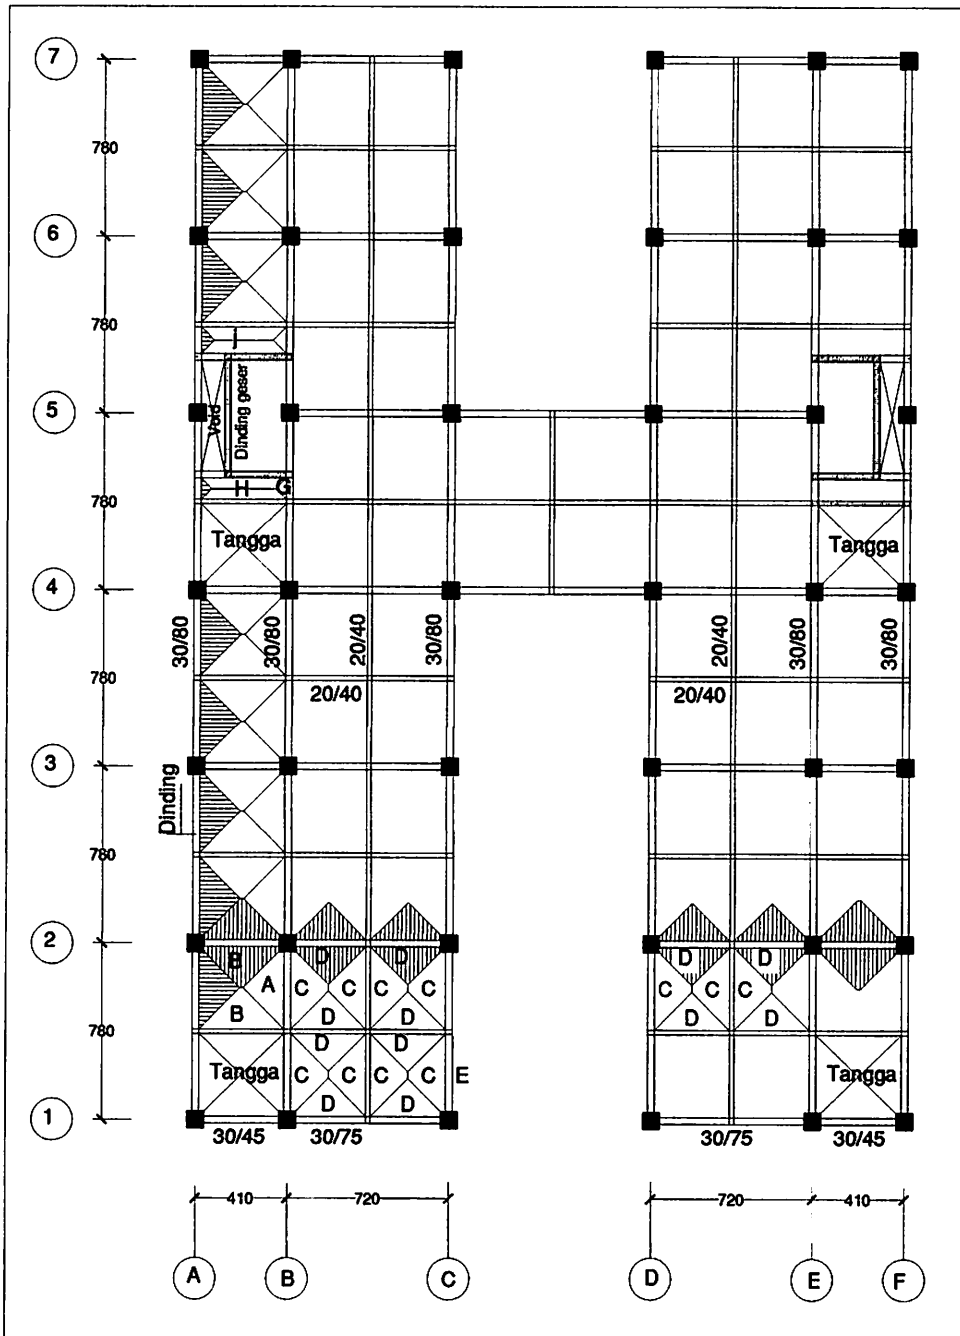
Balok Yang terbebani Pelat Lantai 2
